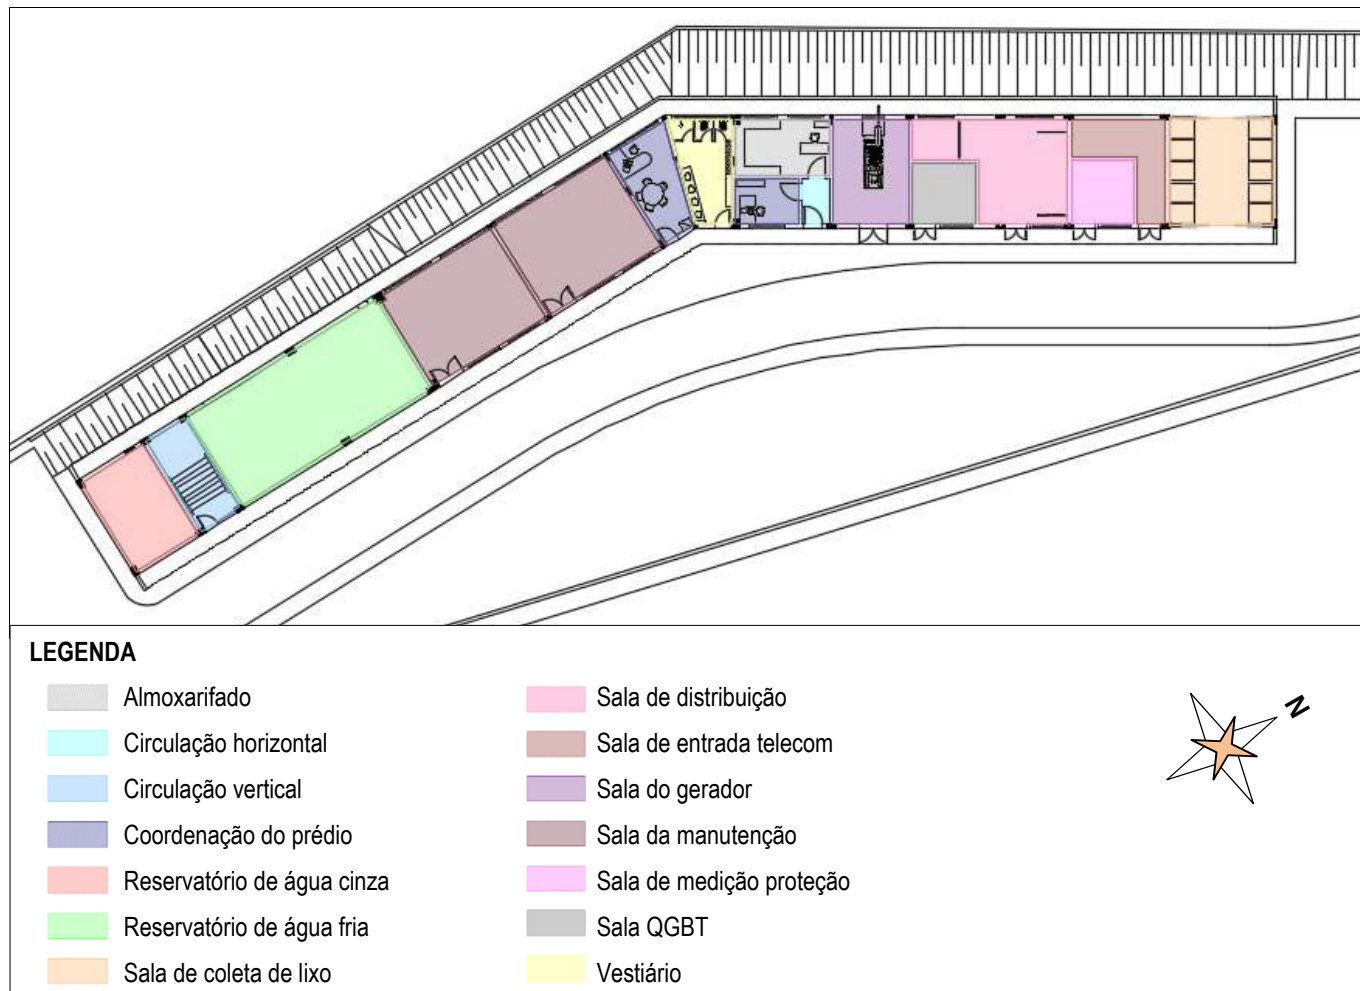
Planta setorizada do pavimento único do bloco 03.
